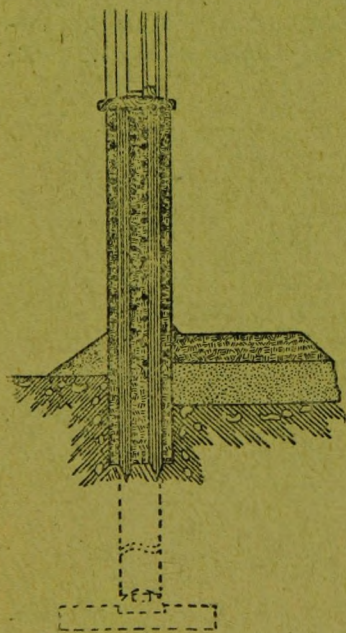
Устройство крестовины для стоек глино-плетневых стен
